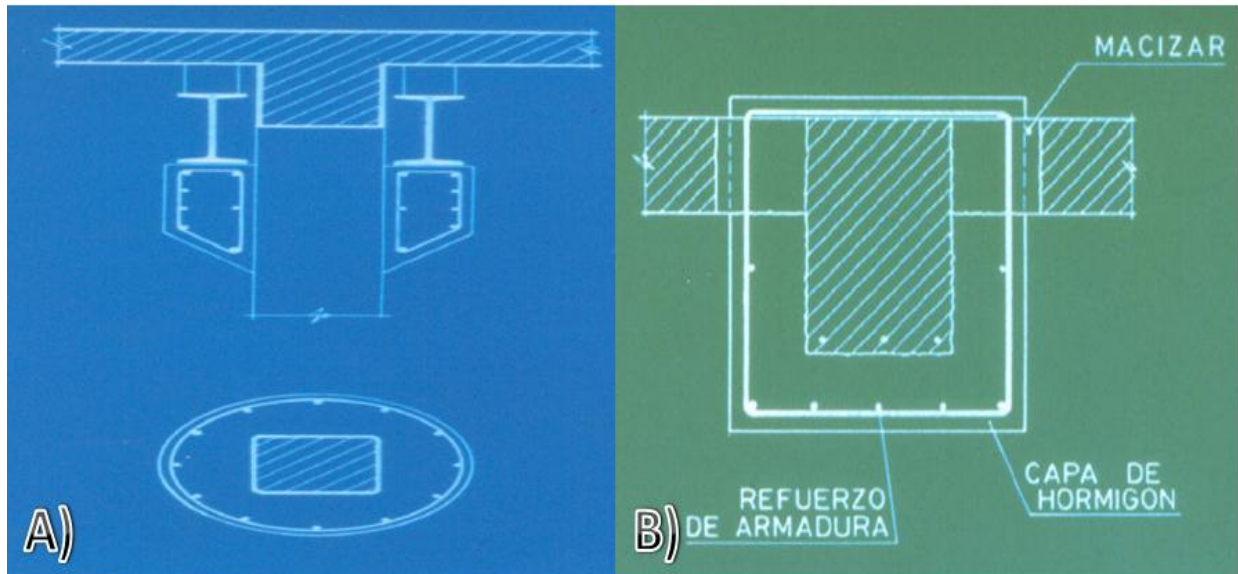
A) Zuncho de un pilar; B) Refuerzo de hormigón en viga que se puede incorporar armadura (Casas Rius, 2012)
